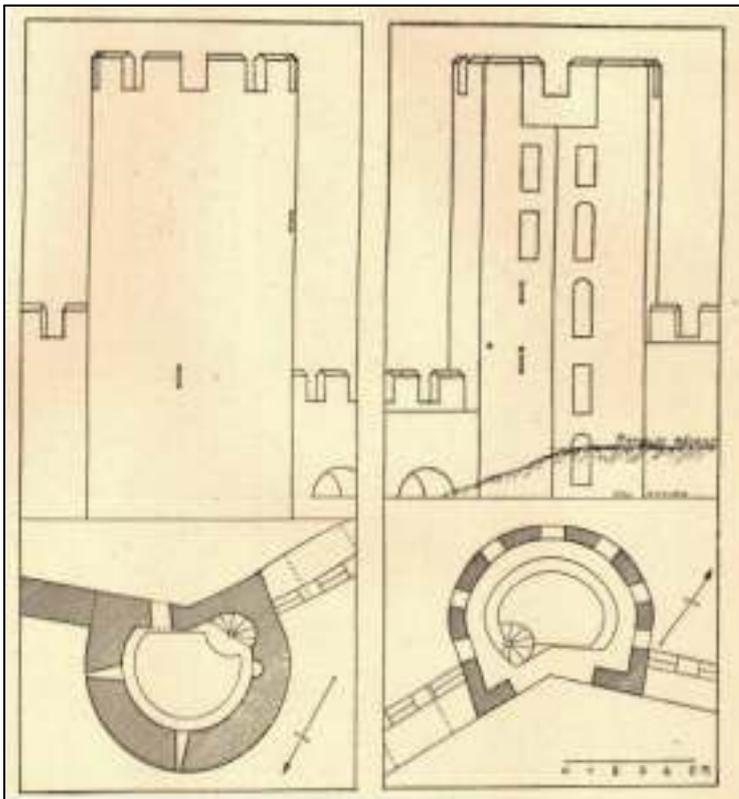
Sezione e pianta della torre di nord-ovest (sopra in legenda la numero 9).
